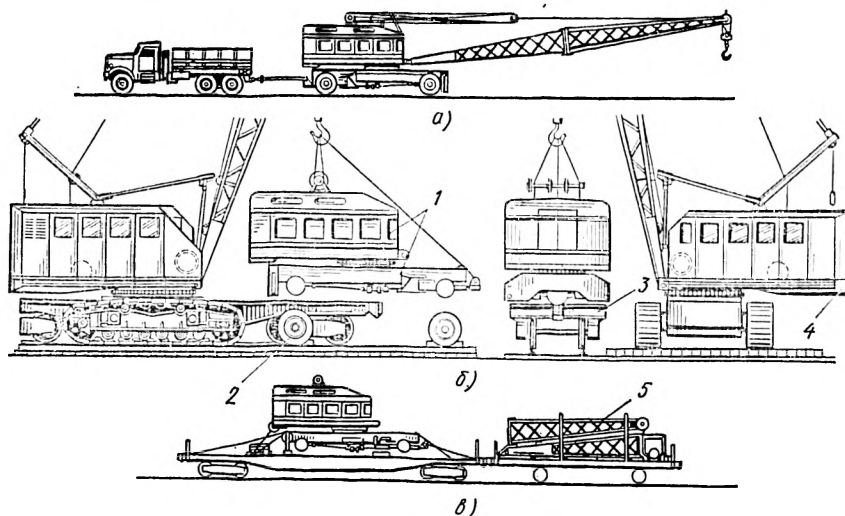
Схемы демонтажа, погрузки и перевозки пневмоколесного крана КС-5363:
